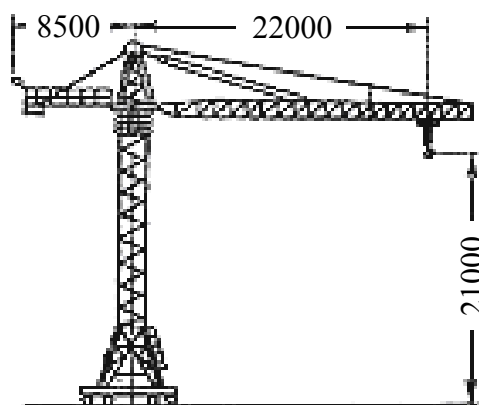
Башенный кран БКСМ-14ПМ2 [7]
